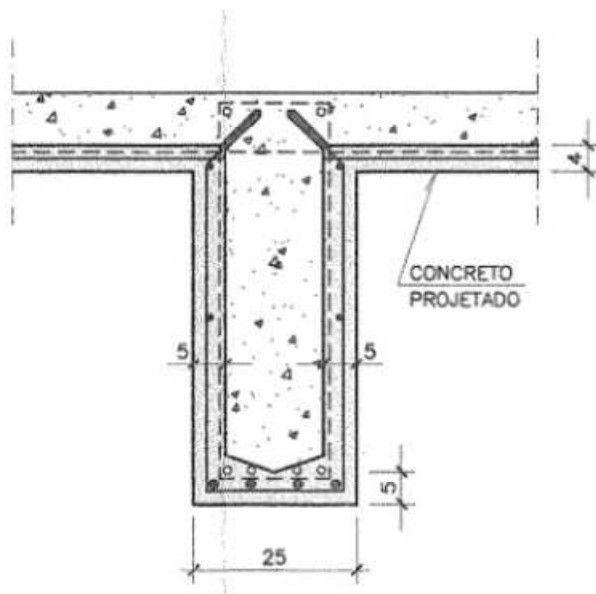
Detalhe de projeto da estrutura após o jateamento.
